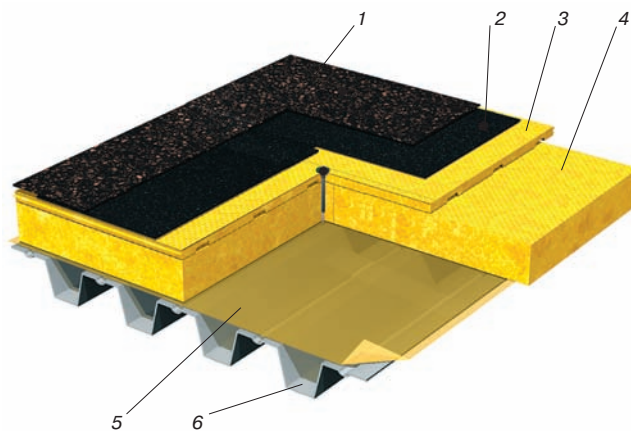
Конструкция покрытия с рулонной кровлей и тепловой изоляцией из плит ISOVER OL-TOP, ISOVER OL-P по несущему основанию из профилированного металлического настила: 1 – защитный слой; 2 – гидроизоляционный ковер; 3 – верхний теплоизоляционный слой из плит ISOVER OL-TOP; 4 – основной теплоизоляционный слой из плит ISOVER OL-P; 5 – пароизоляционный слой; 6 – несущее основание из профилированного настила
